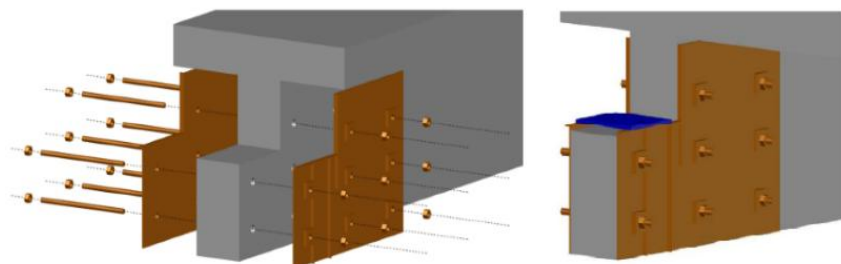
Placcaggio esterno con piastre d'acciaio: vista in sezione (a) vista laterale (b) (Bertagnoli et al. 2023)
